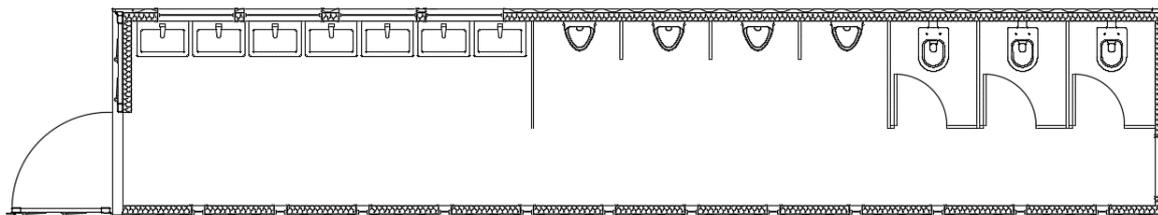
Planta Baixa Módulo 01 - Masculino. Fonte: elaborado pelos autores.
